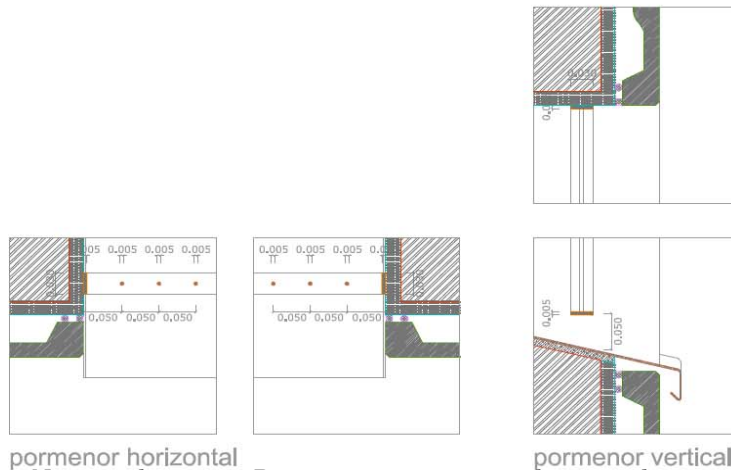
Novo gradeamento. Pormenores construtivos horizontal e vertical (escala 1/20).
